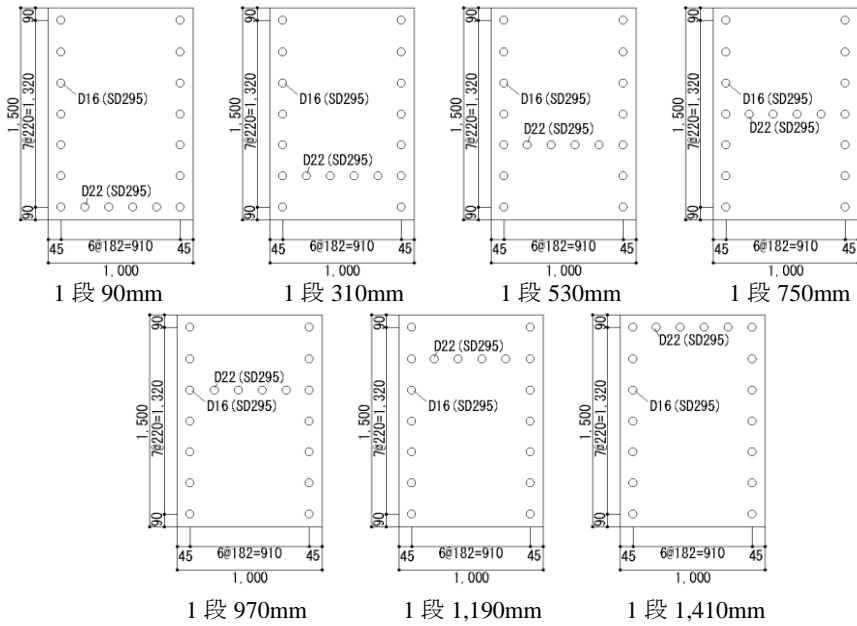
解析モデルの配筋図（1段配置：数字は下面から鉄筋中心までの距離）
